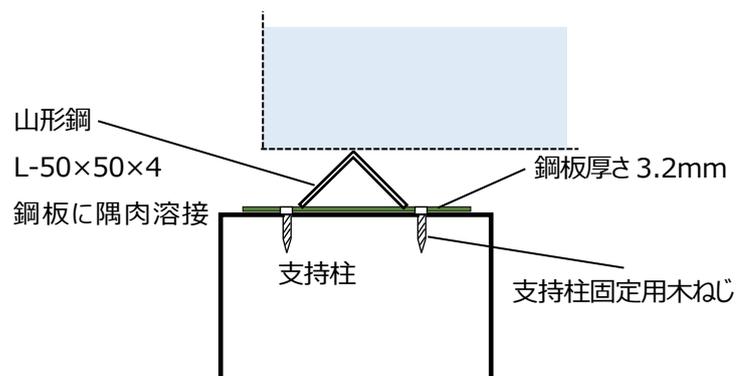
Ra, Rb 支点付近断面詳細図 (B-B 断面図) 単位 : mm
